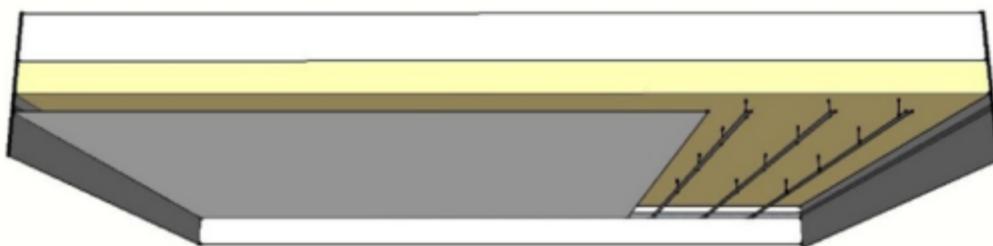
Plafond constitué de fourrures et de dispositifs de suspension avec lame d'air (hors ERP)
